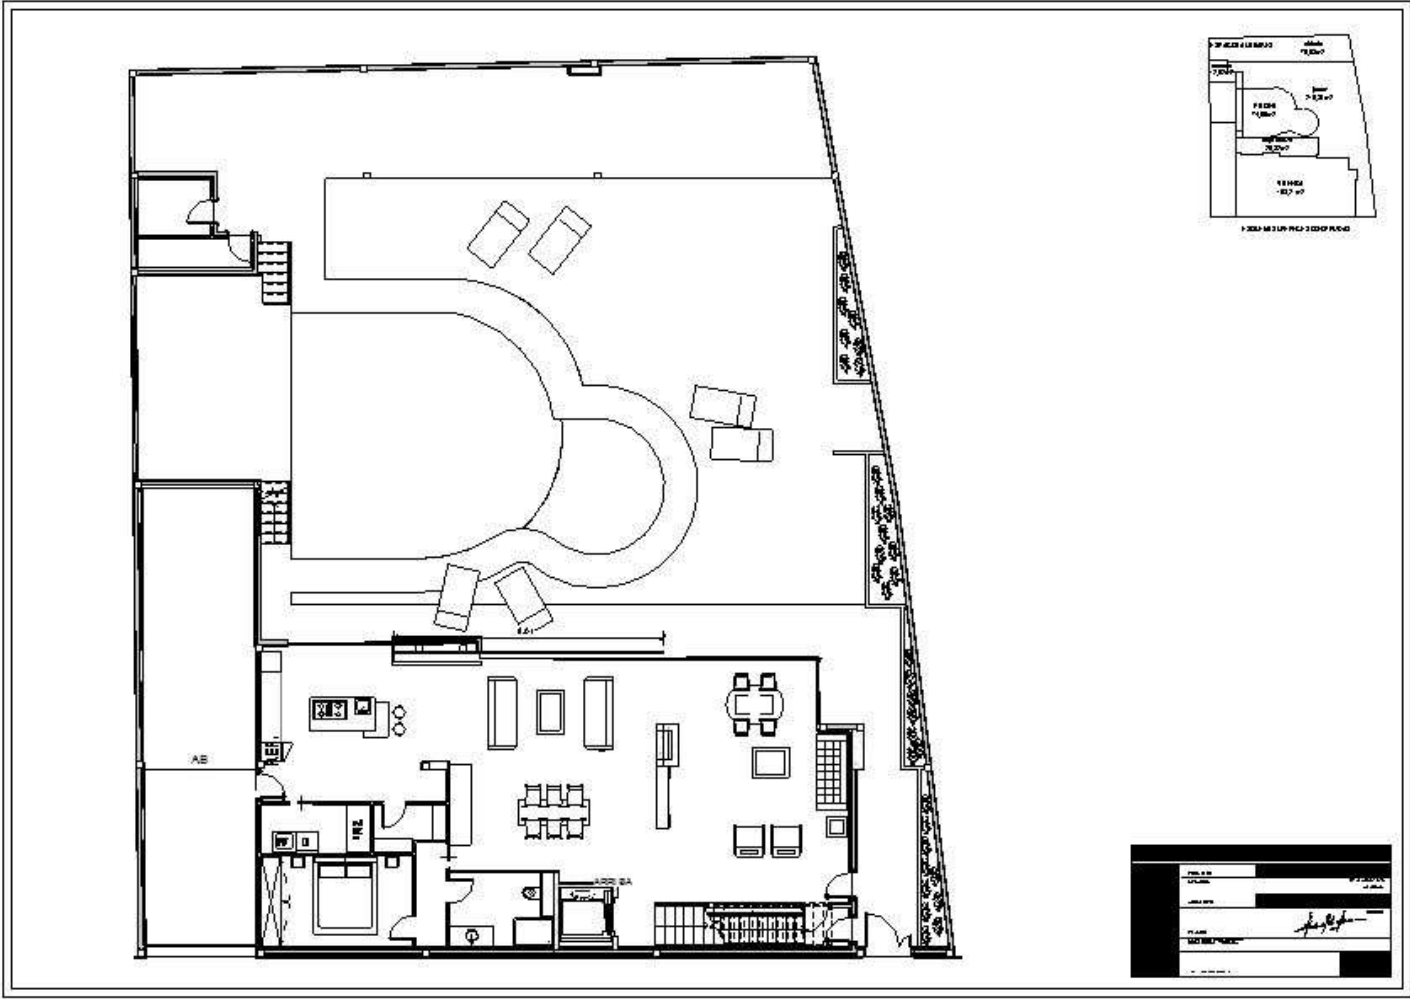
Plano Arquitectónico A-2. Planta Baja. Fuente propia. 2016
